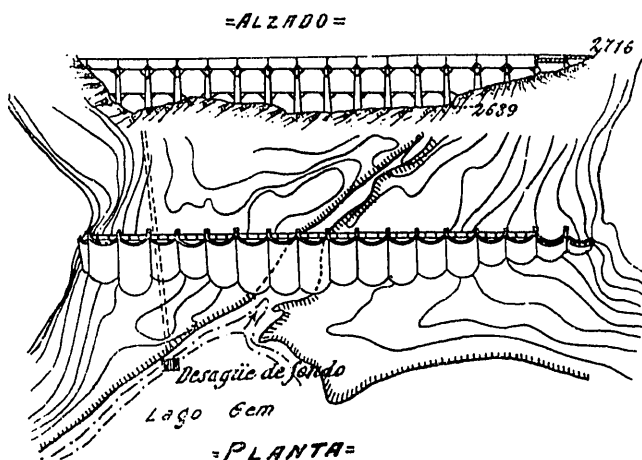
^a Alzado (lado de aguas abajo) y planta de la presa de Gem.
